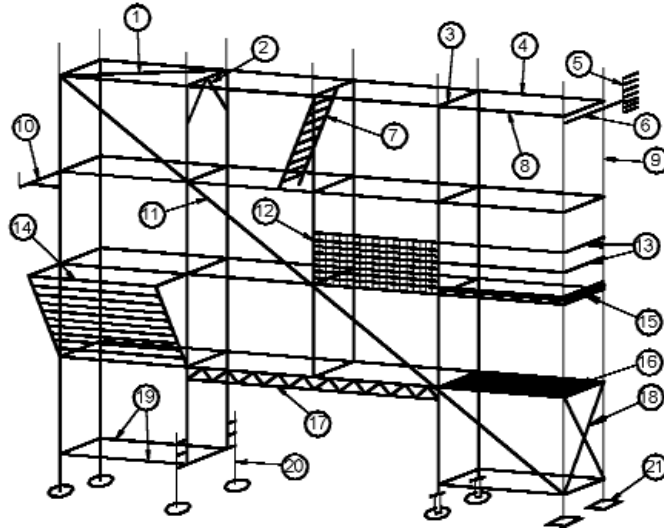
Nomenclatura degli elementi principali di un ponteggio: 1 diagonale in pianta, 2 archetto di rinforzo telaio, 3 collegamento trasversale, 4 corrente posteriore, 5 ancoraggio, 6 collegamento, 7 scaletta, 8 traverso, 9 montante, 10 apparecchio sollevatore, 11 diagonale di facciata, 12 graticcio di protezione, 13 doppio parapetto, 14 mantovana o parasassi, 15 fermapiede, 16 impalcato, 17 trave passo-carraio, 18 rinforzo al primo livello, 19 rinforzo alla base, 20 pezzo speciale, 21 basetta fissa o regolabile.
